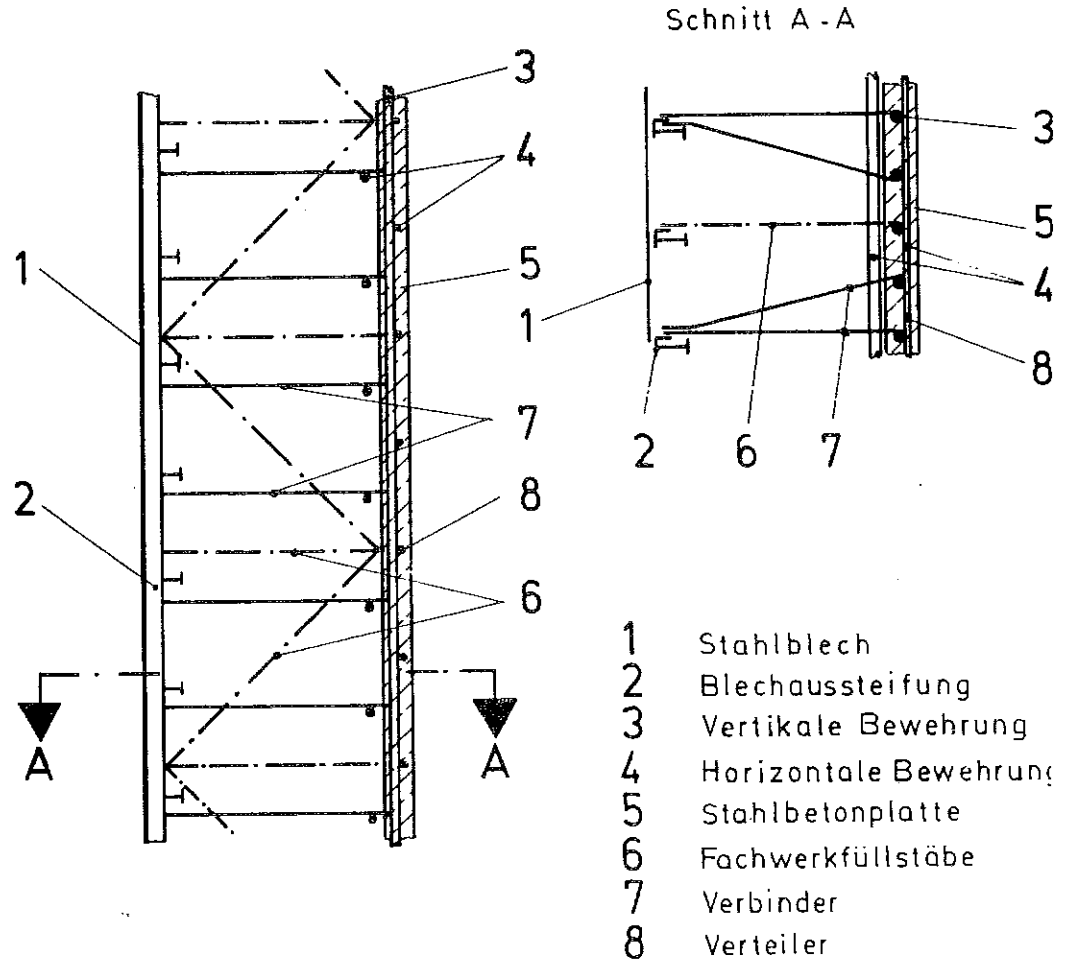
Wandzelle mit einseitiger Blechbewehrung und Stahlbetonplatte (Konstruktions
